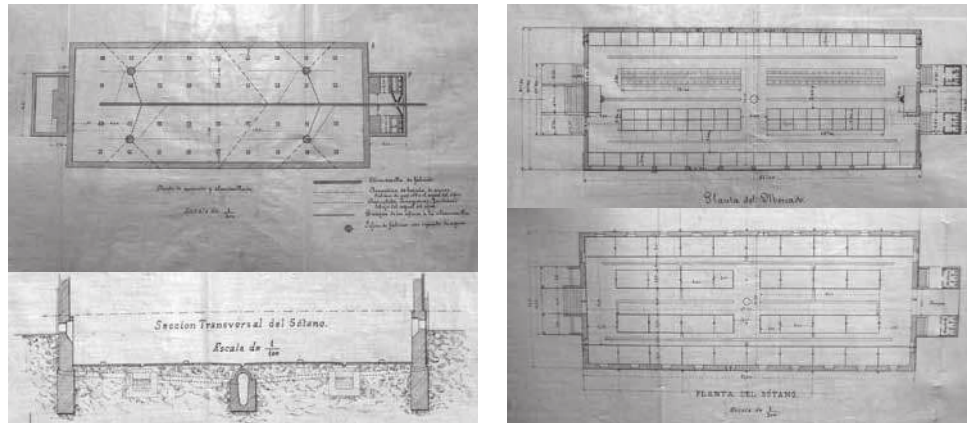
Izquierda. Planta de saneamiento y sección transversal. Derecha. Plantas Principal y Sótano. Mercado de Abastos de Zamora. 1902 [3].
